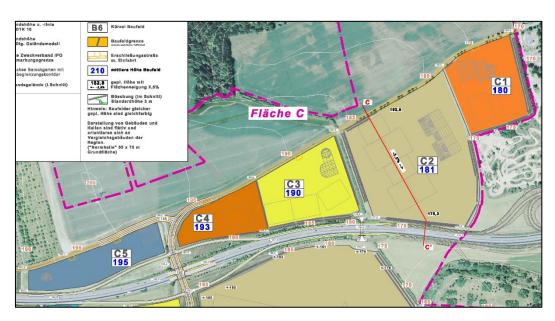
geplante Profilierung Fläche C mit Schnitt C-C' (Original im Anhang)
